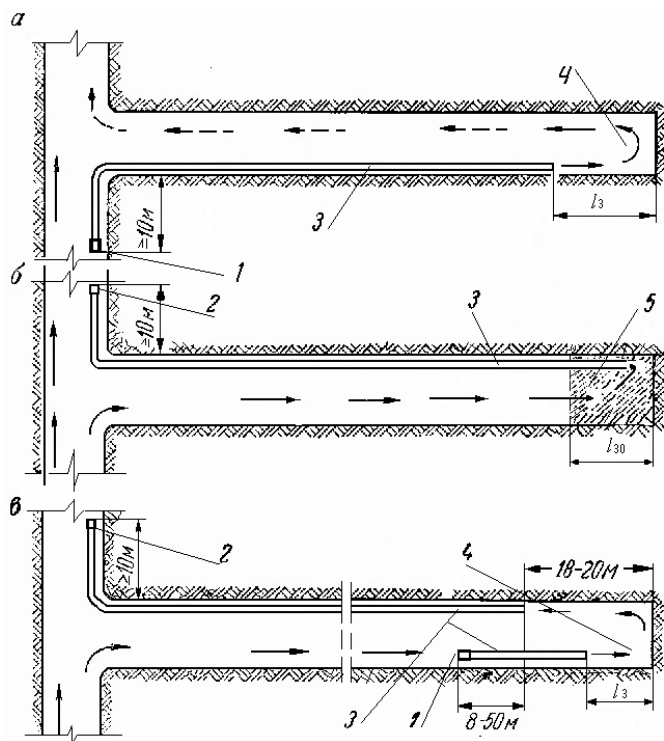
Способы вентиляции забоев проводимых выработок с помощью ВМП: 1 – нагнетательный вентилятор; 2 – всасывающий вентилятор; 3 – трубопроводы; 4 – активная струя в призабойном пространстве; 5 – зона отброса газов после взрывных работ (20-30м)
